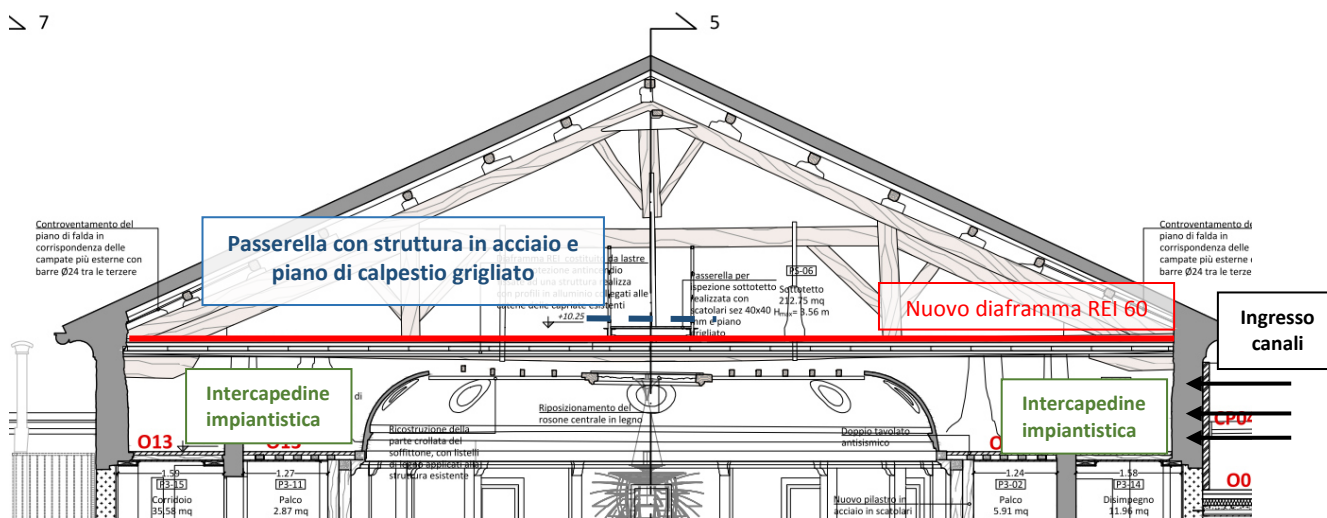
Estratto di sezione trasversale della sala al centro del soffittone
